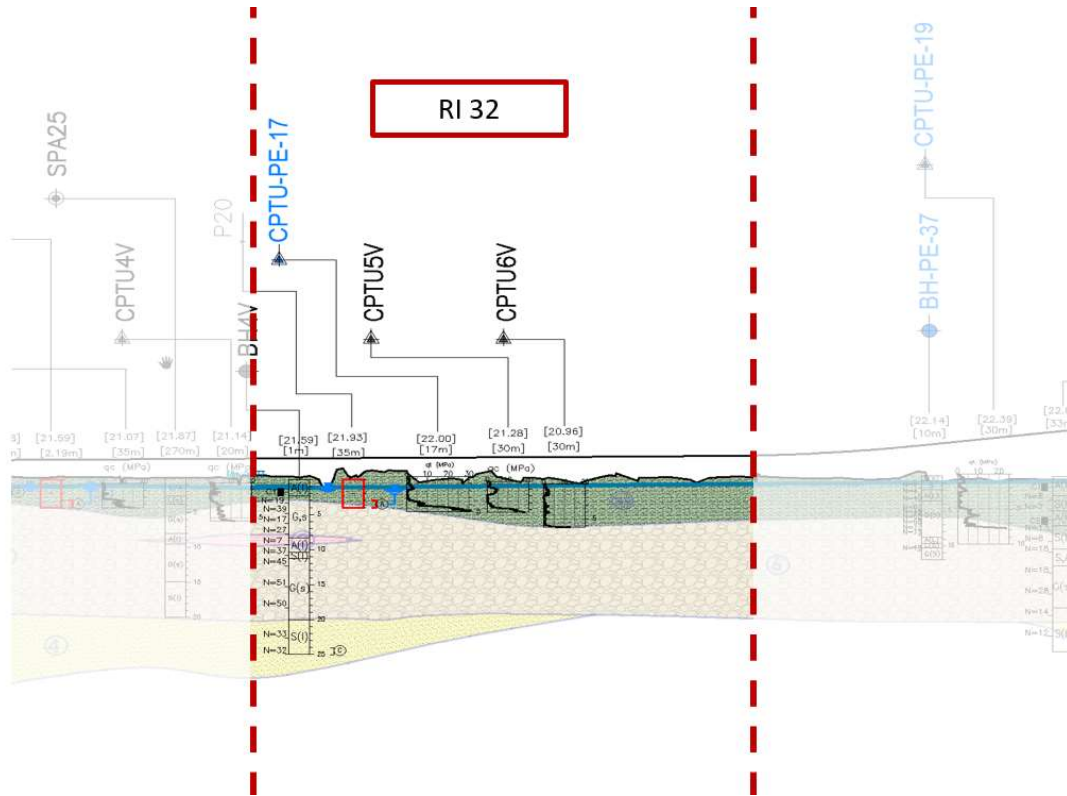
Profilo Geotecnico Rilevato RI32, estratto dal Profilo Geotecnico Generale (Doc. Rif. [3])
